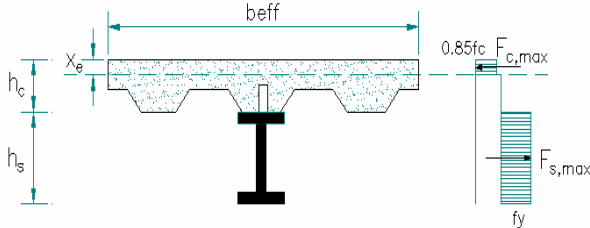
Distribución de esfuerzos plásticos con eje centoidal en la losa de concreto
